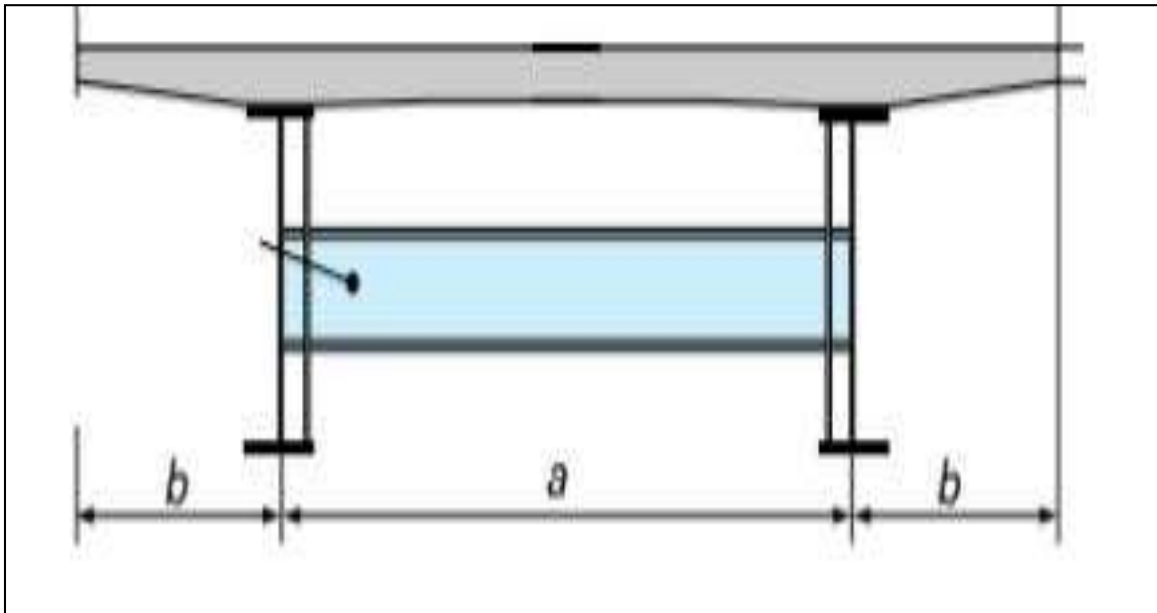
Coupe transversale d'un tablier bipoutre.
